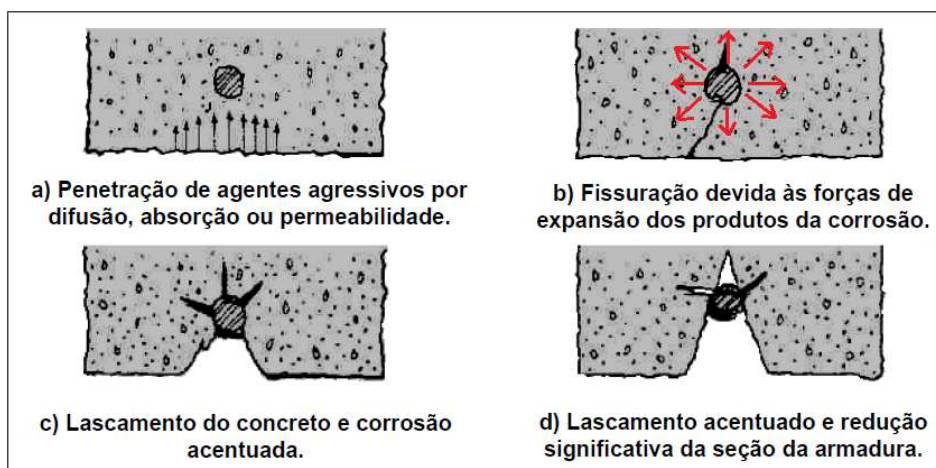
Fases da instalação da corrosão em uma barra de armadura. Fonte: Helene (1986) *apud* Polito (2006).
